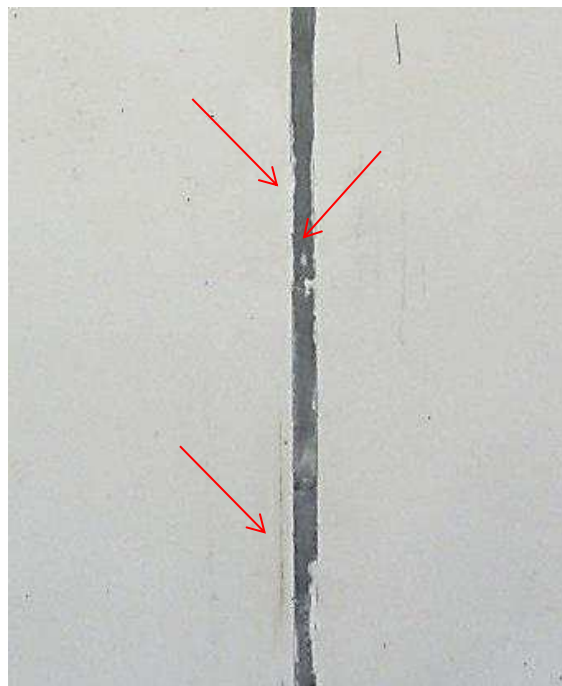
Fissuras no local da junta de movimentação após a aplicação do selante.
